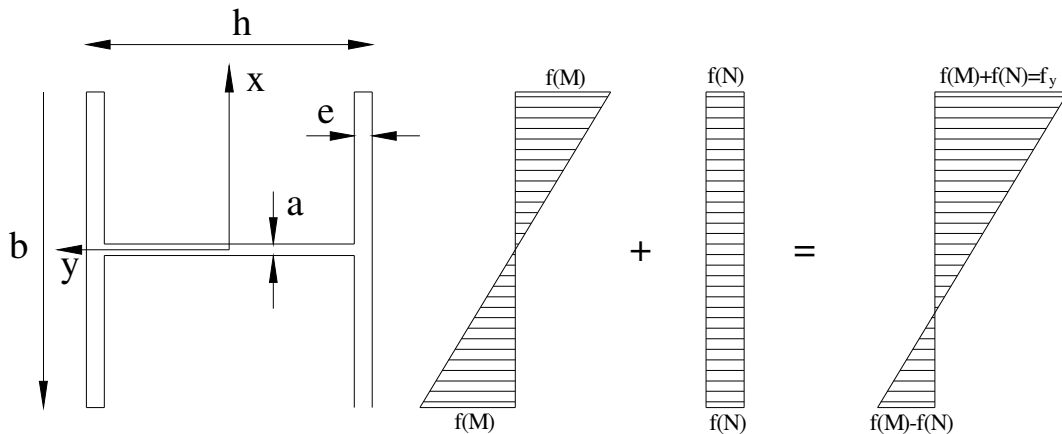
Tensioni della sezione nella condizione di snervamento.
